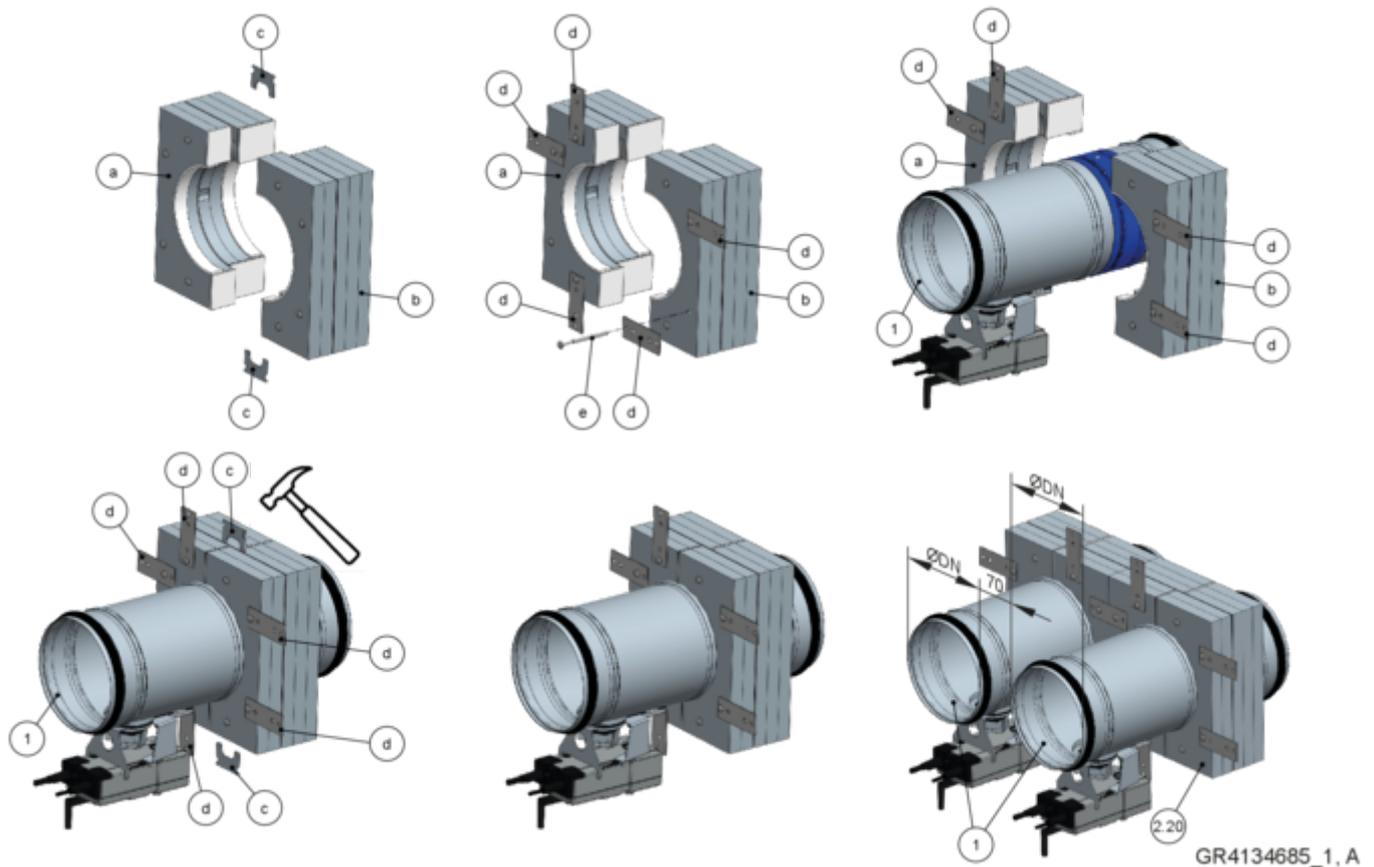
Lieferumfang und Montage Einbausatz TS2 für Trockeneinbau
